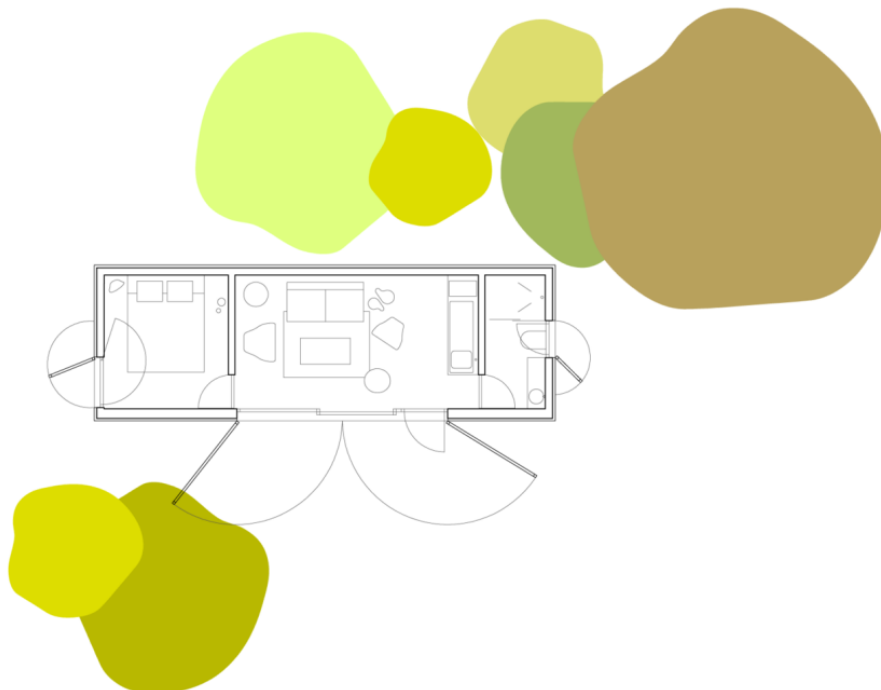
/ 3: Planta de casa industrializada.
